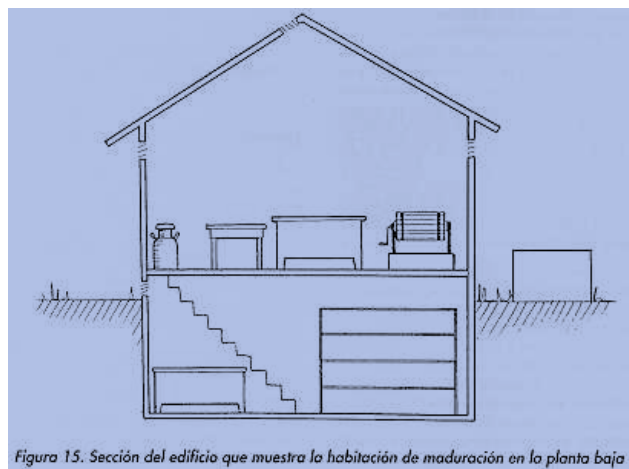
Sección del edificio que muestra la habitación de maduración en la planta baja
